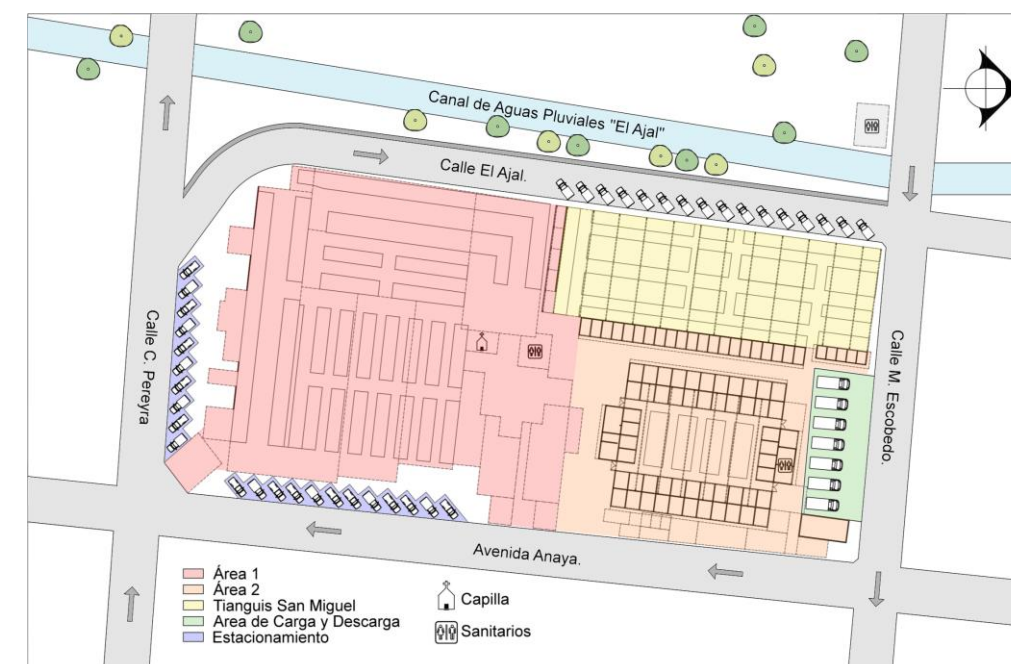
Levantamiento Arquitectónico Otoño 2012.
